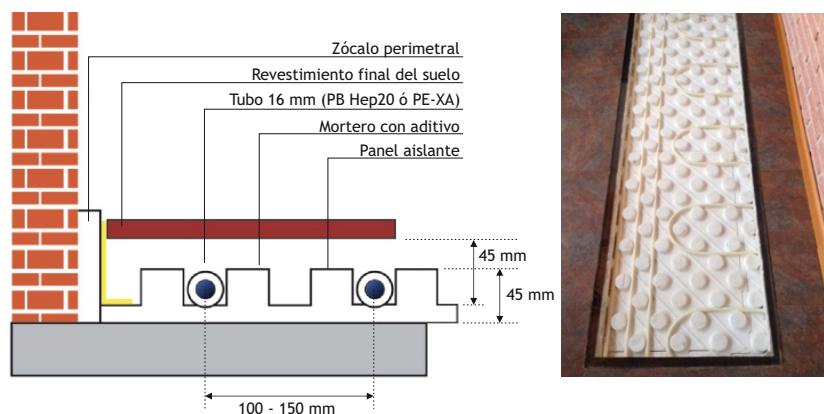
Detalle constructivo e imagen suelo radiante.
